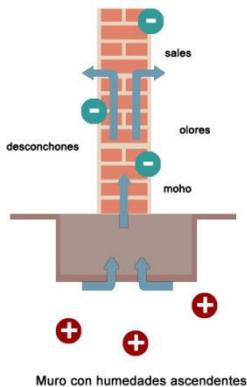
Muro con humedades ascendentes (Fuente: [www.muroterm.com](http://www.muroterm.com))
